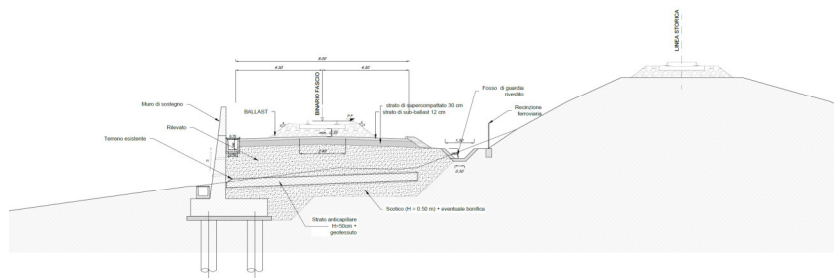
Binario Piazzale Porto, singolo binario con muro di sostegno
